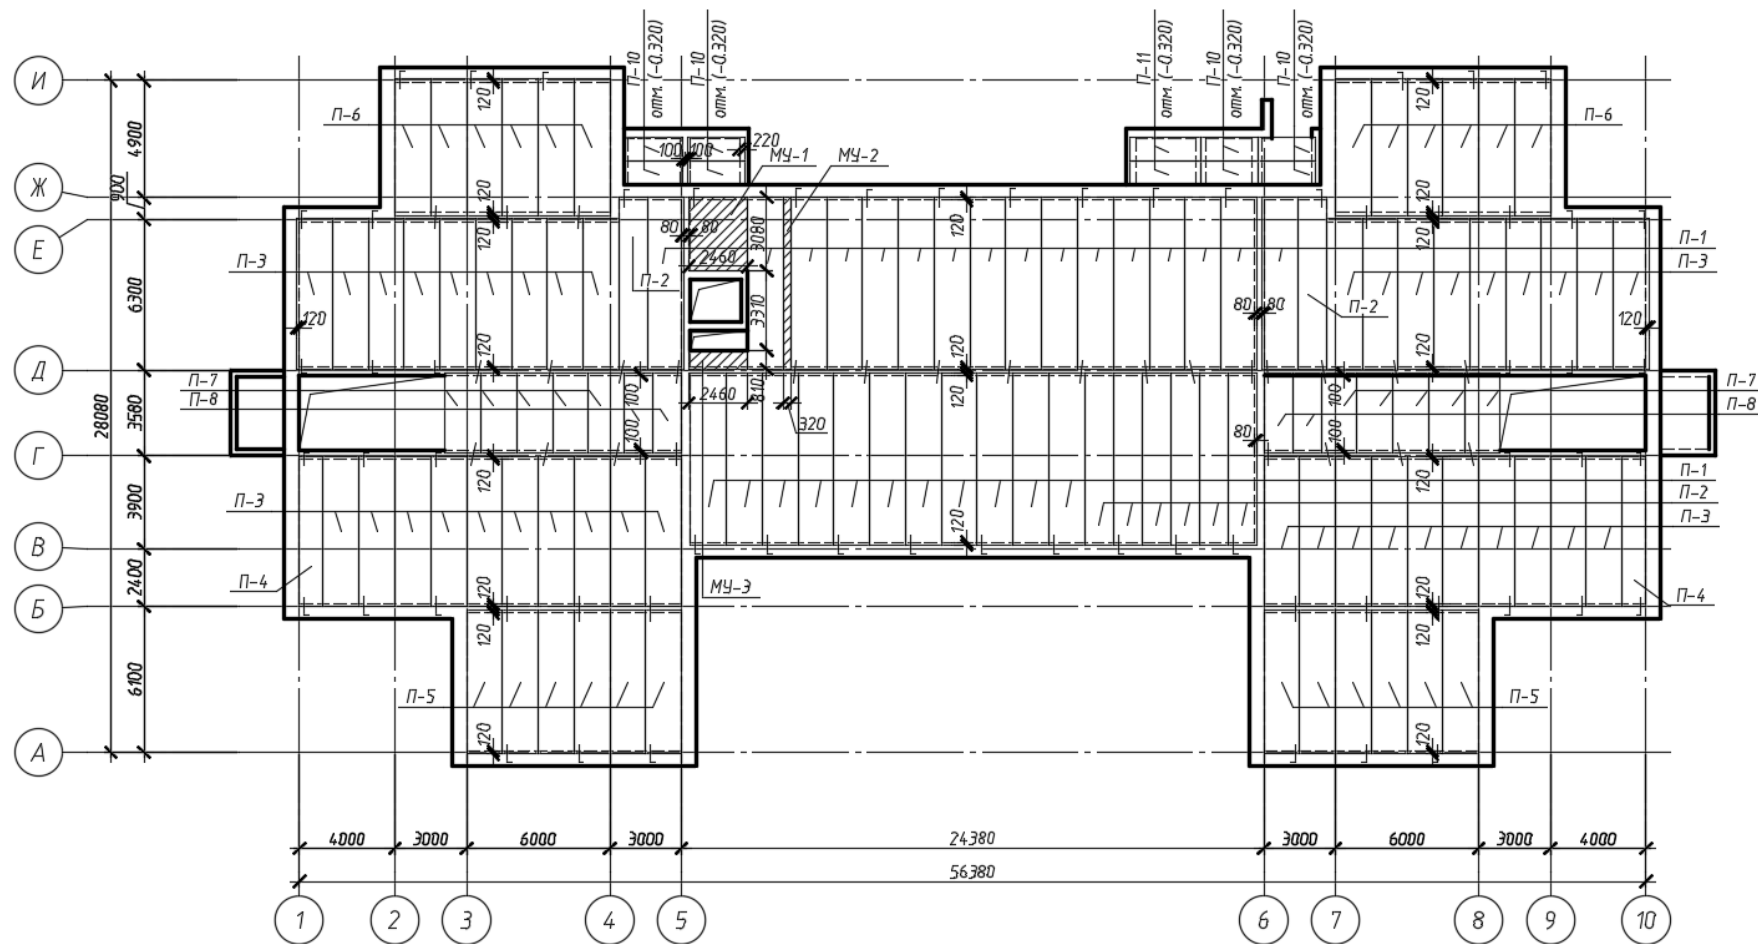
Схема расположения элементов перекрытия на отм. 0.000
